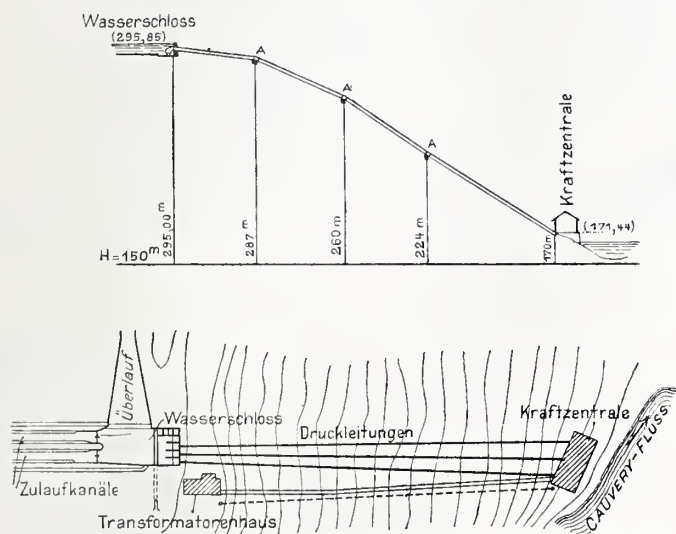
Längenprofil und Lageplan der Druckleitung.
